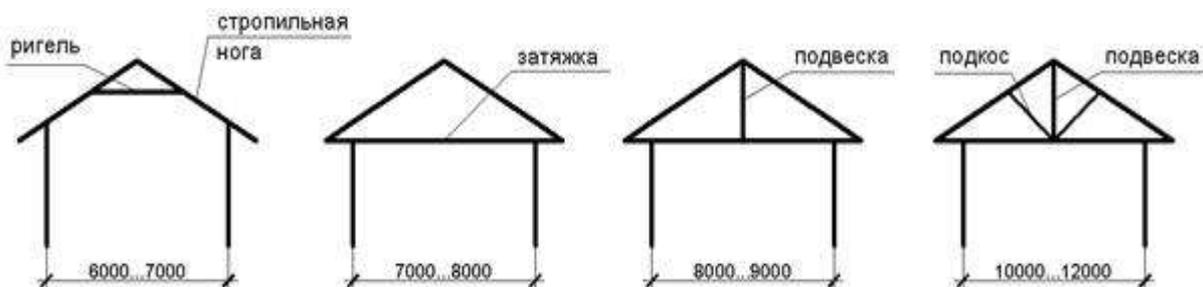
Скатная крыша. Варианты устройства стоек и подкосов, подвесок
